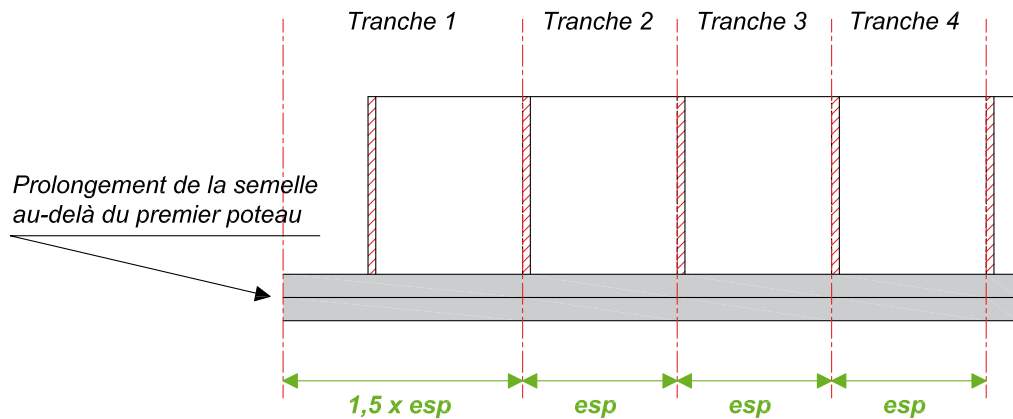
Principe de découpage en tranche de la semelle de fondation
